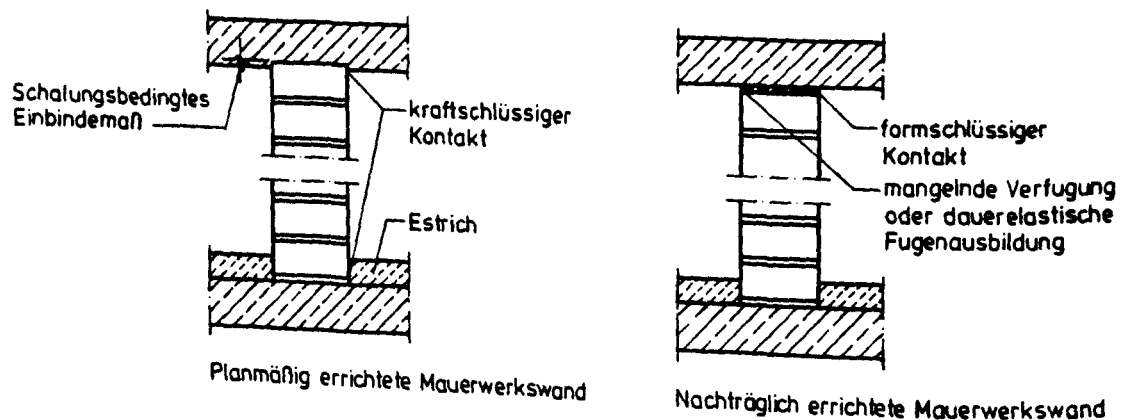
Form- und kraftschlüssiger Kontaktschluß von Mauerwerkswänden im Bereich des Wand-Decken-Knotens
